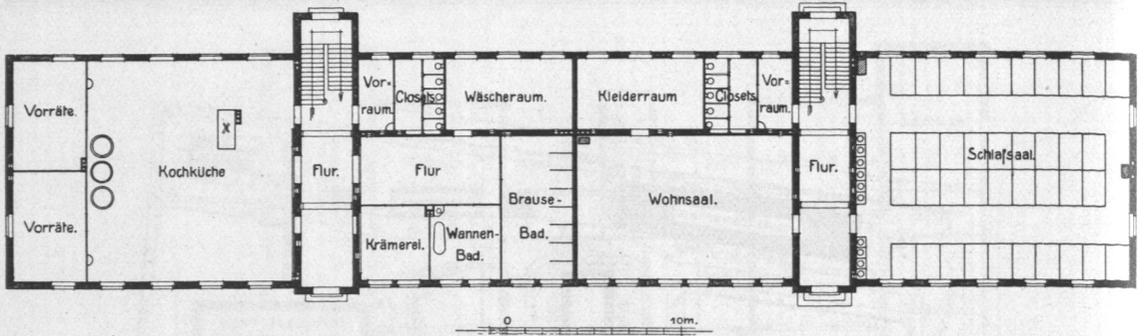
Werk- und Armenhaus in Farmsen, großes Frauenhaus, Erdgeschoß, Grundriß.
